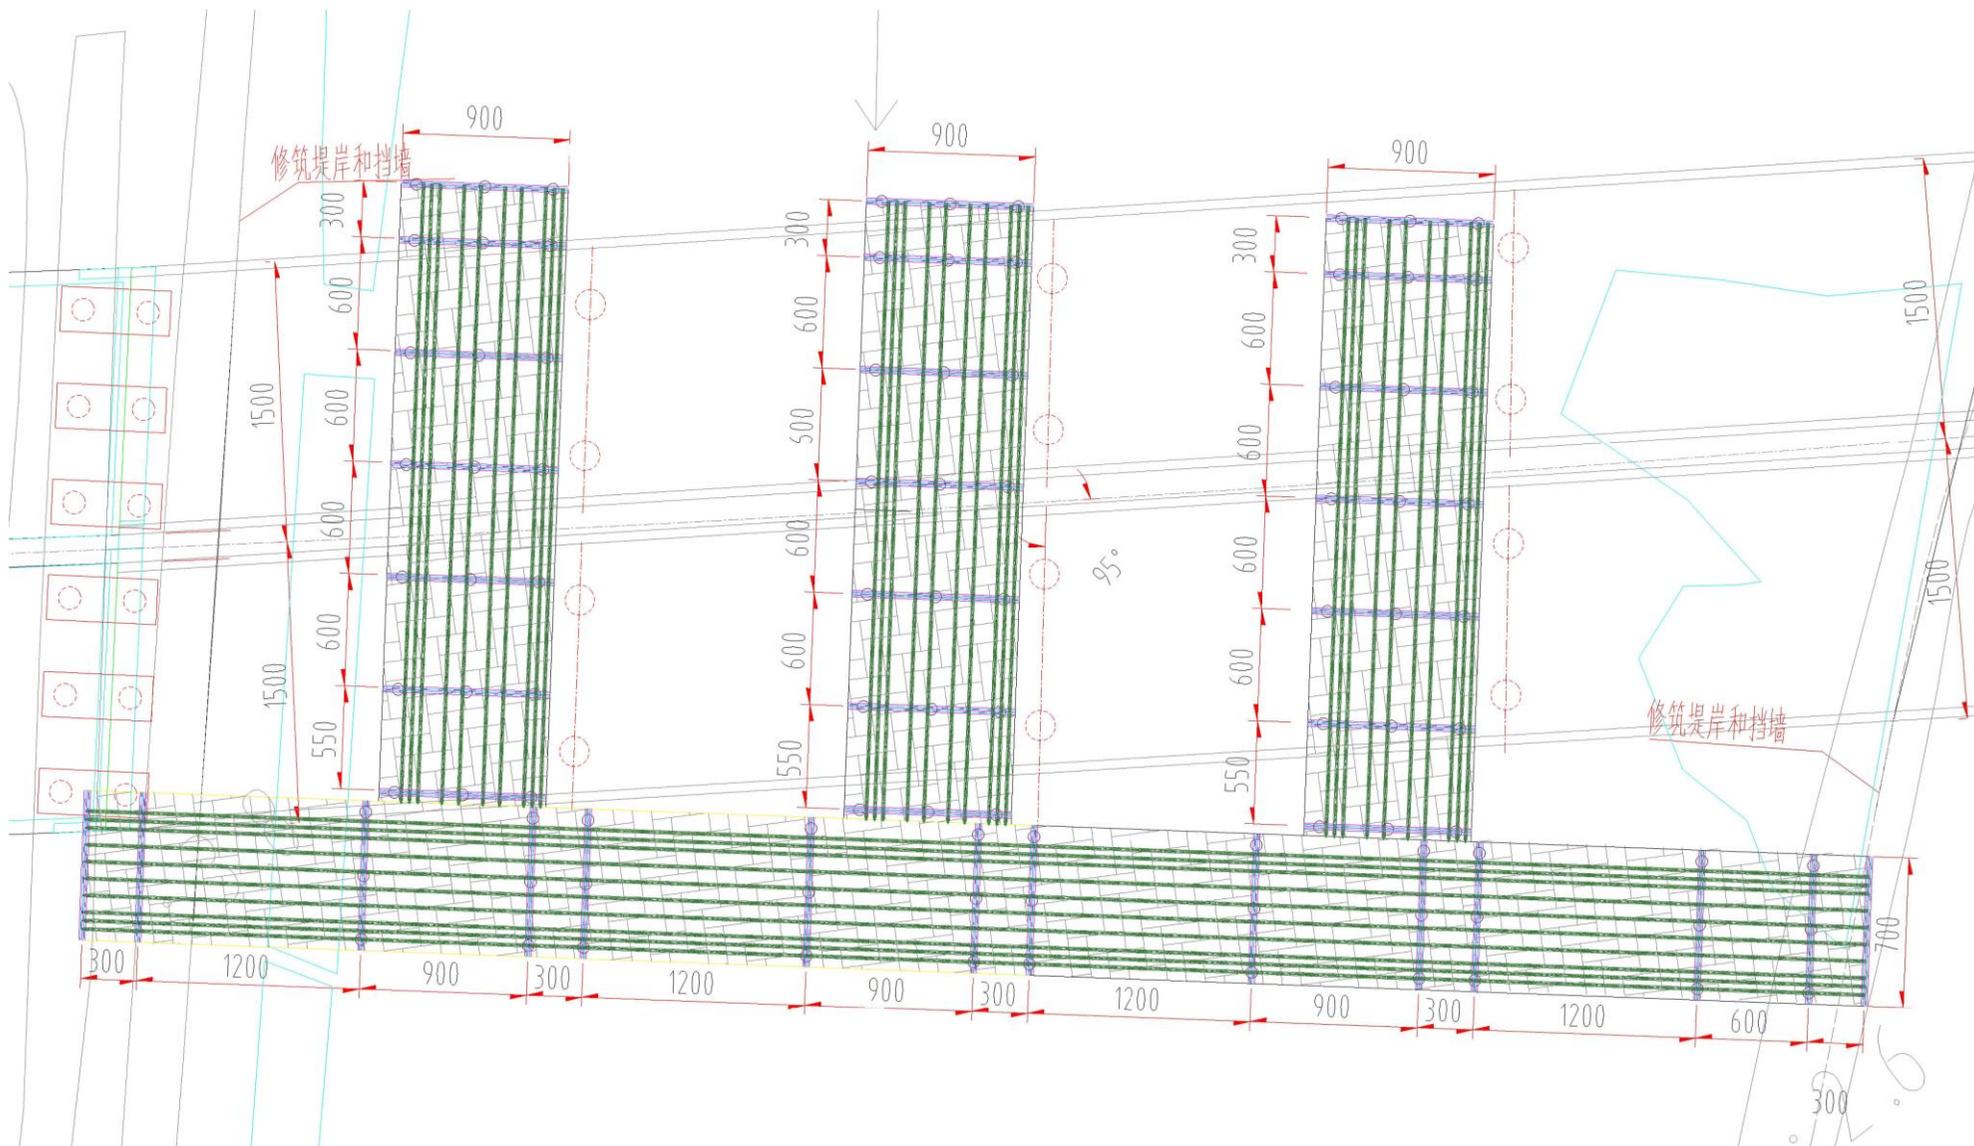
宝楼河大桥施工栈桥总体布置图
